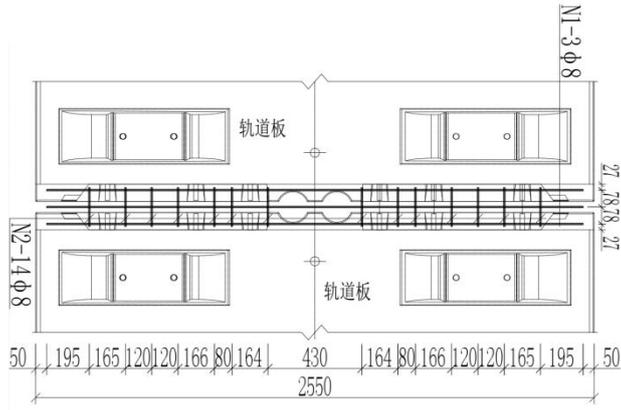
宽接缝钢筋平面布置图 (单位: mm)
